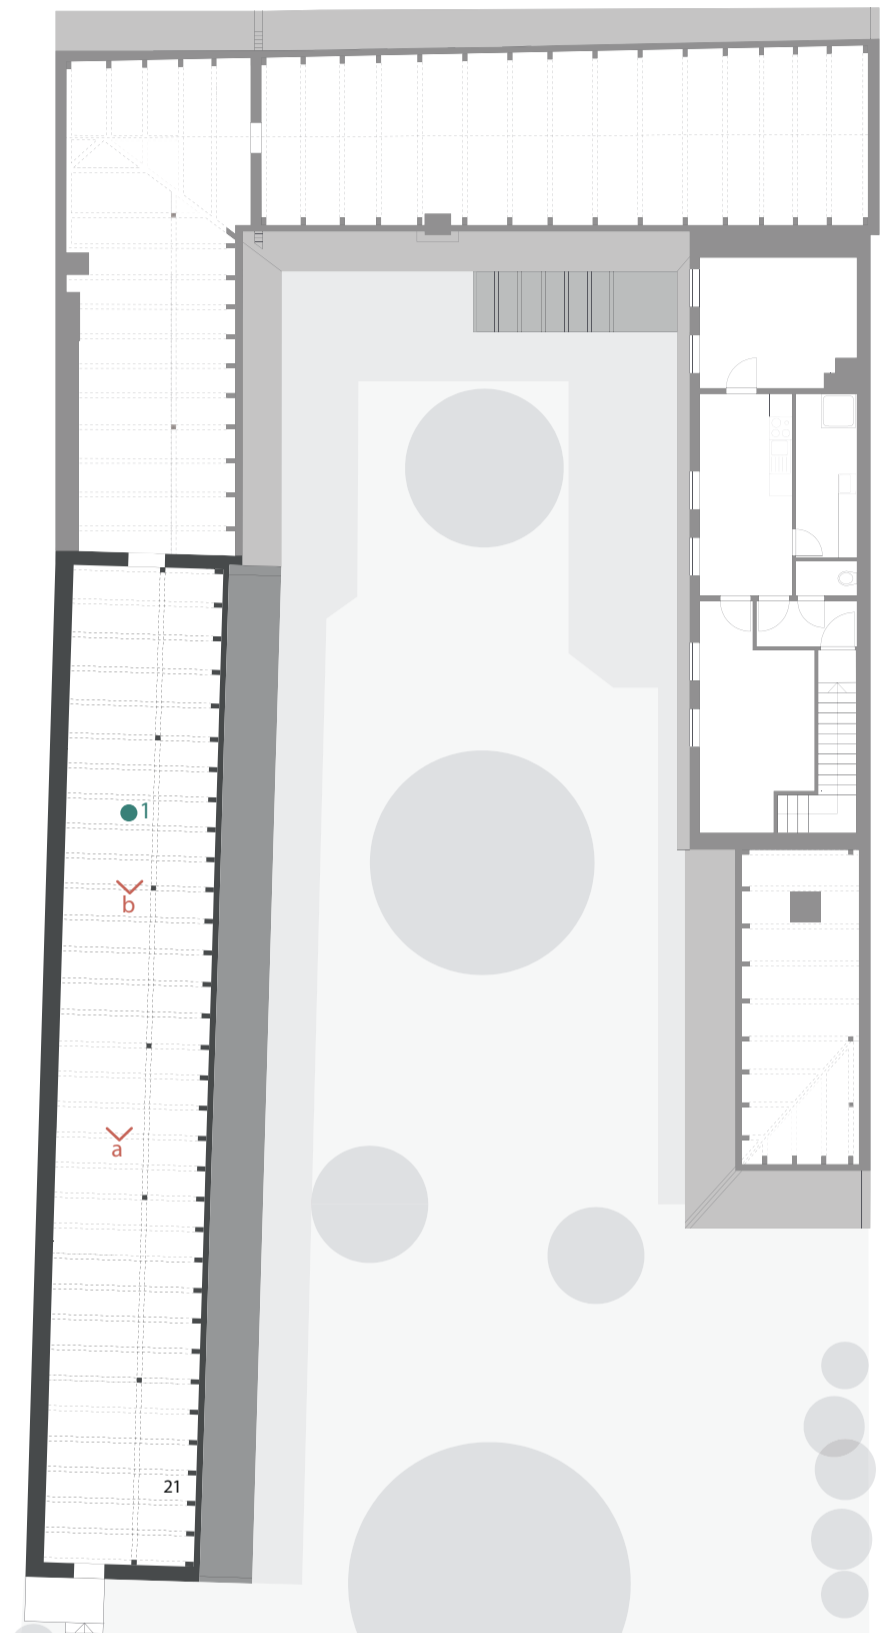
Grundriss Dachgeschoß | M 1:200 | Raum 21
